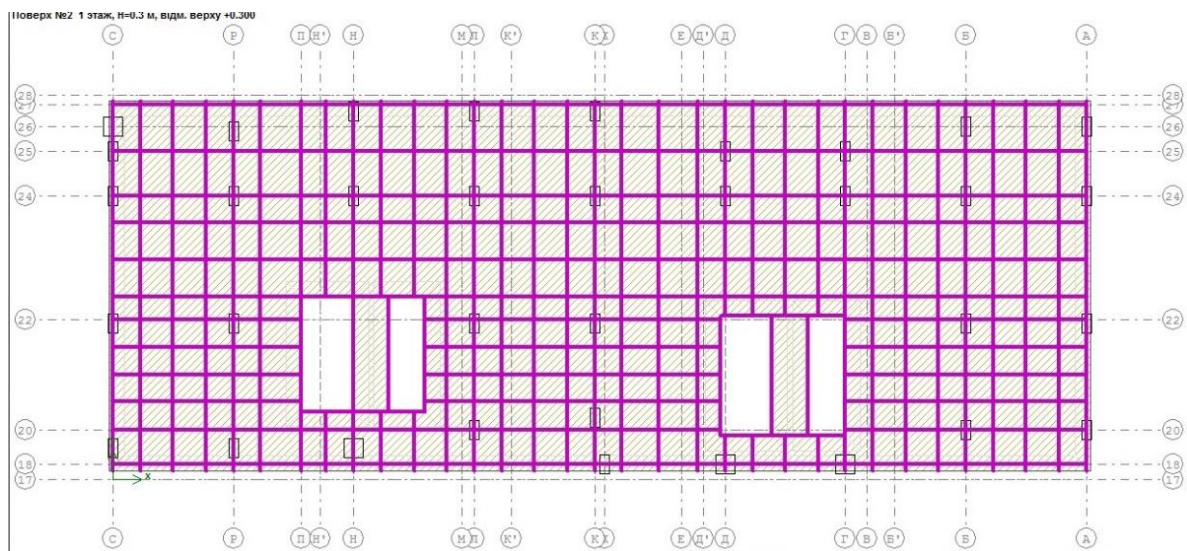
Схема влаштування плит перекриття будівель та фрагменти їх СЕ моделей
